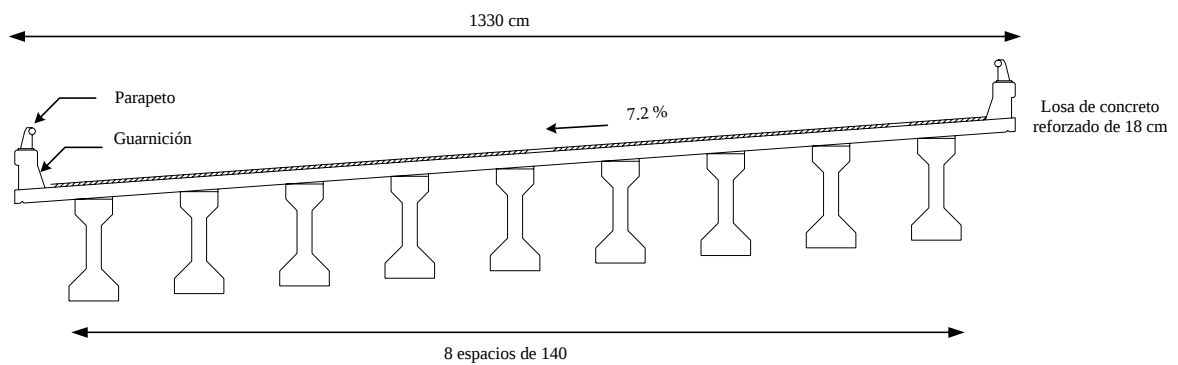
Sección transversal de la superestructura entre el apoyo 3 y 6
